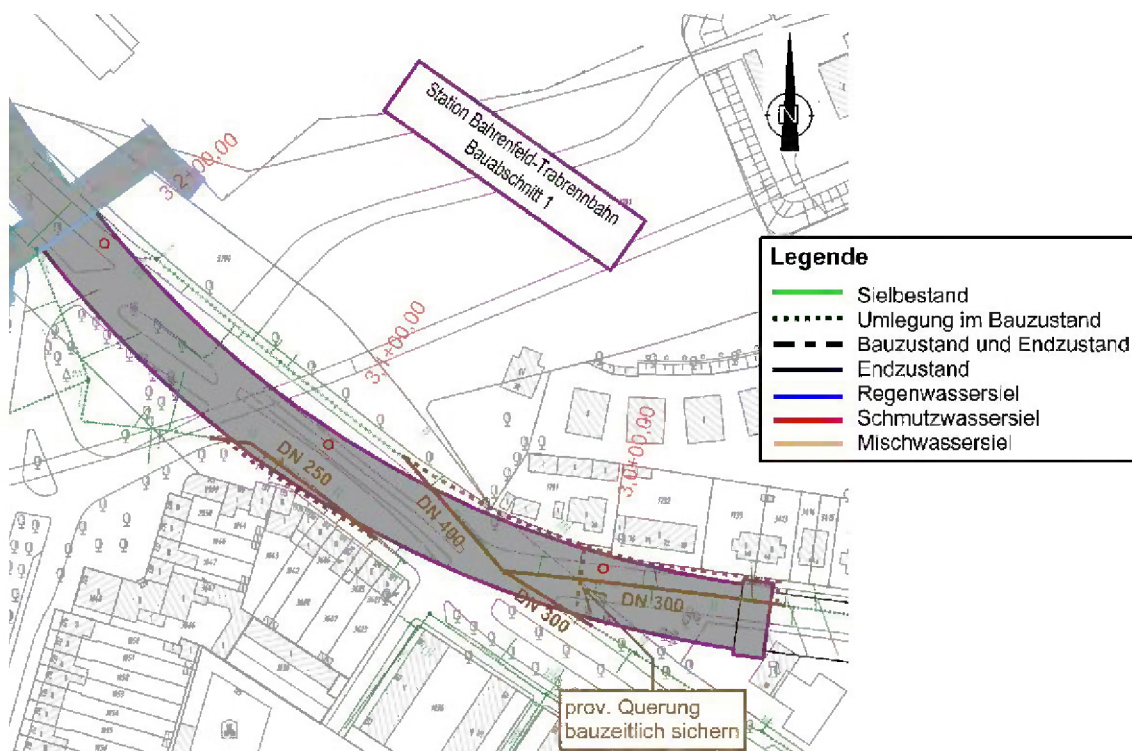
Sielplan Baubereich Station Bahrenfeld Trabrennbahn, Bauabschnitt 1 (Stand 04.2019)
